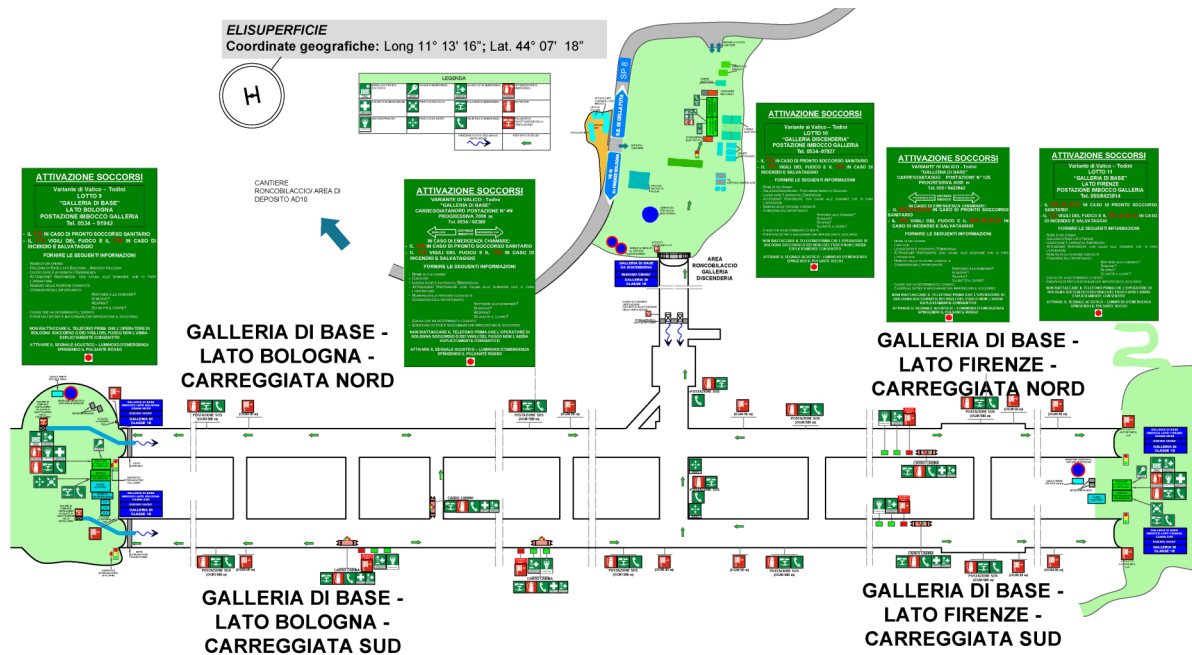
Galleria di Base - Planimetria generale al termine lavori di scavo
